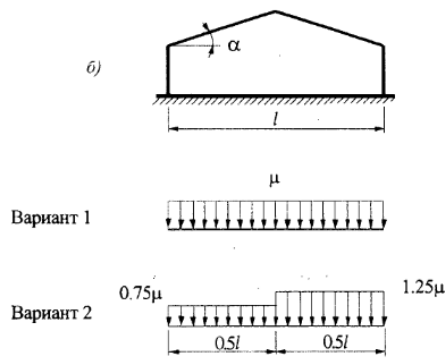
Схема распределения снеговой нагрузки для треугольной фермы
